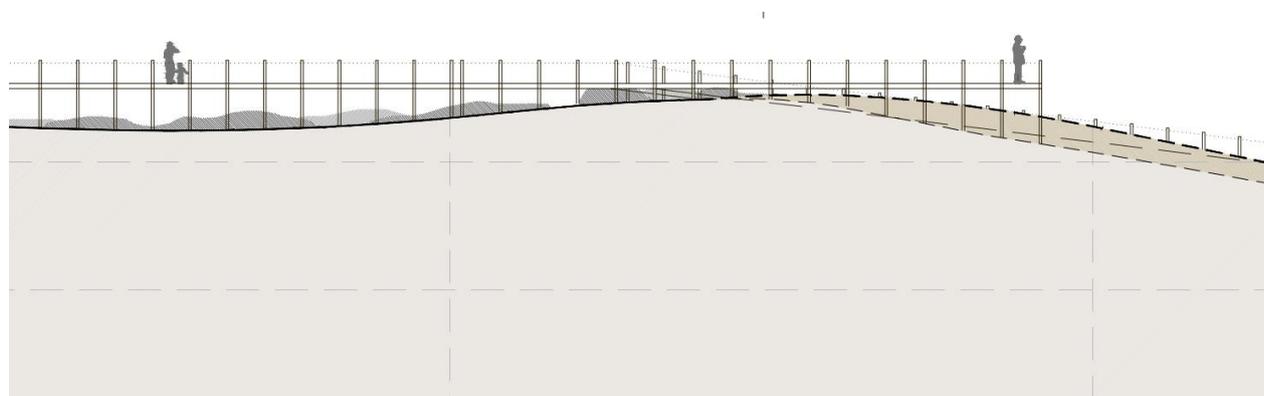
Passadiço elevado em madeira e miradouro simples – Perfil Transversal - Plano Geral
